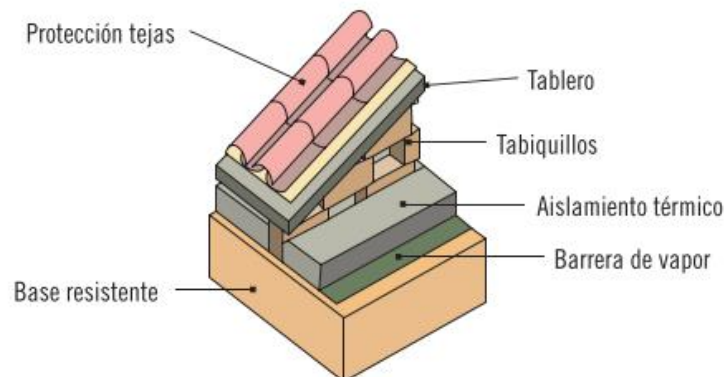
Aislamiento térmico en cubierta inclinada sobre soporte horizontal.
